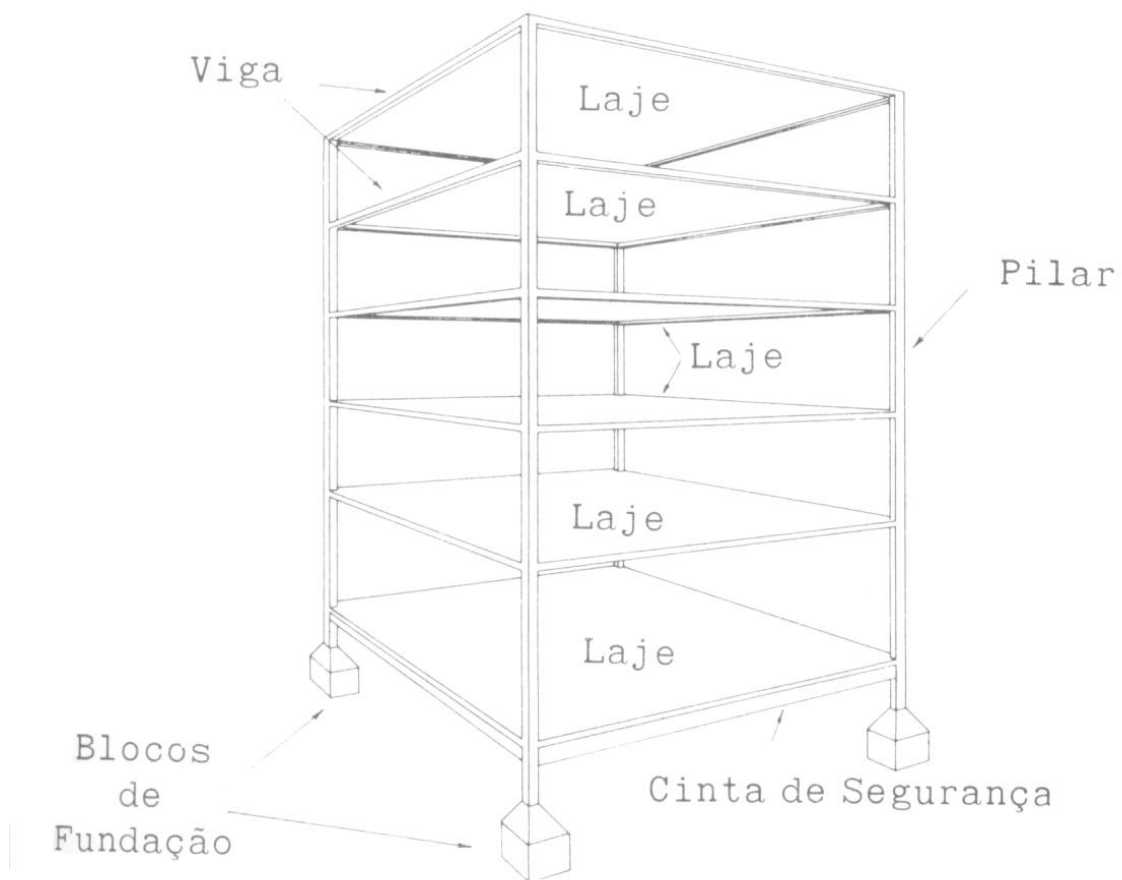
Perspectiva da estrutura de concreto armado de um prédio de vários pavimentos.
